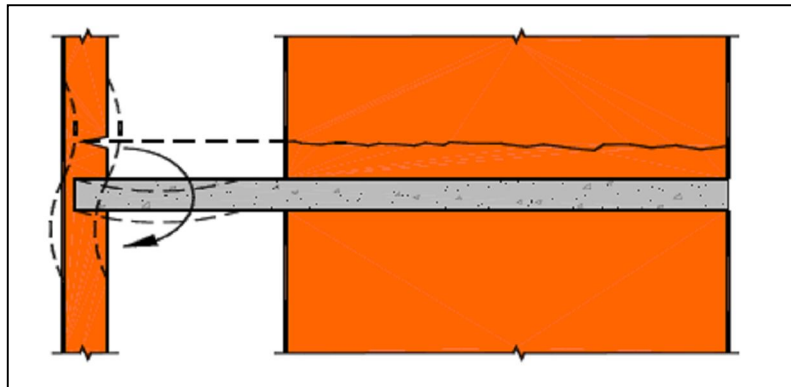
Fissuração horizontal na base da parede provocada pela deformação excessiva da laje. [37]
